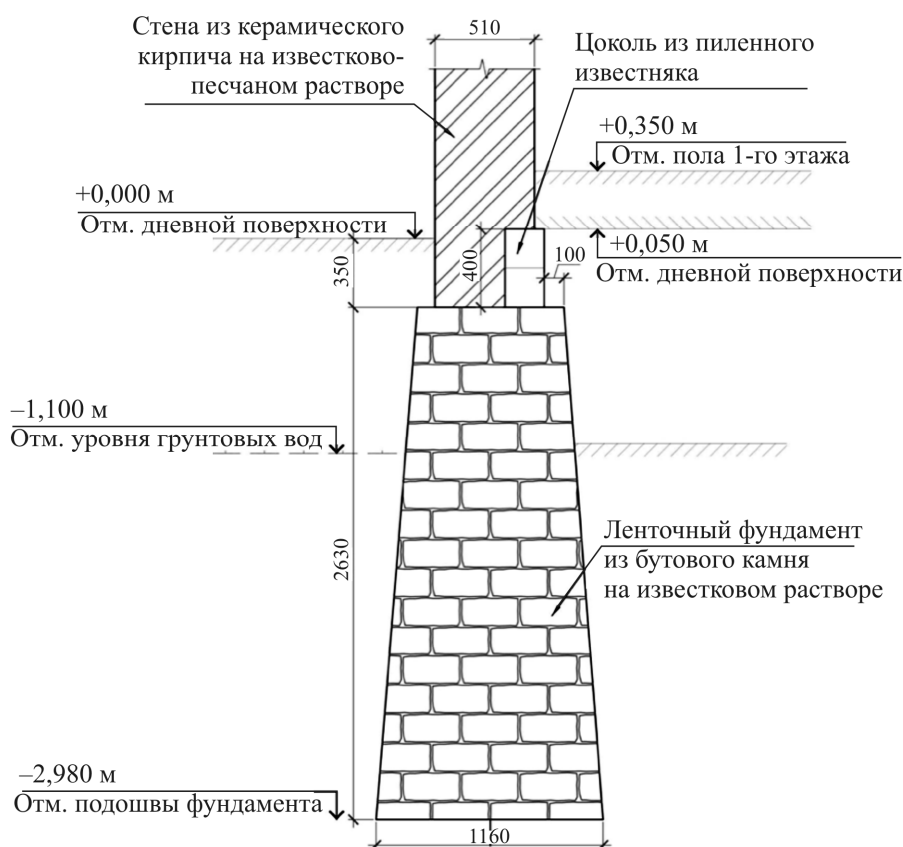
Ленточный бутовой фундамент под наружные и внутренние стены здания на естественном основании
